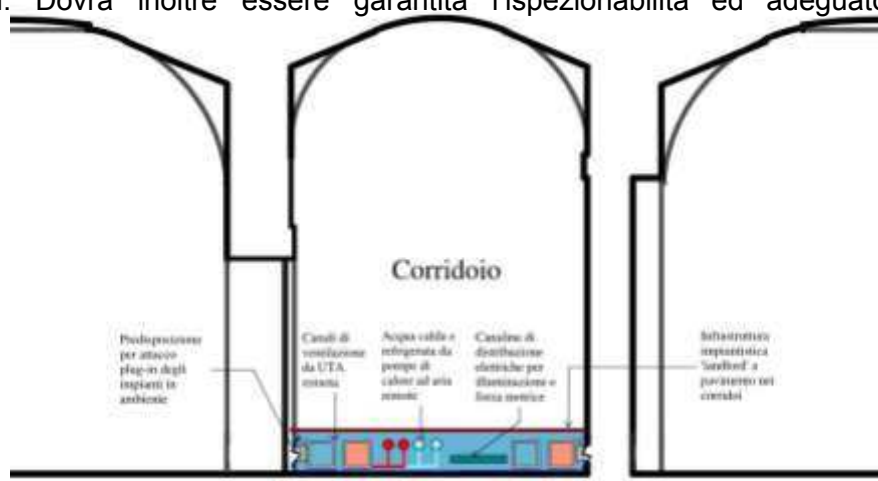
Distribuzione orizzontale degli impianti a pavimento lungo i corridoi
